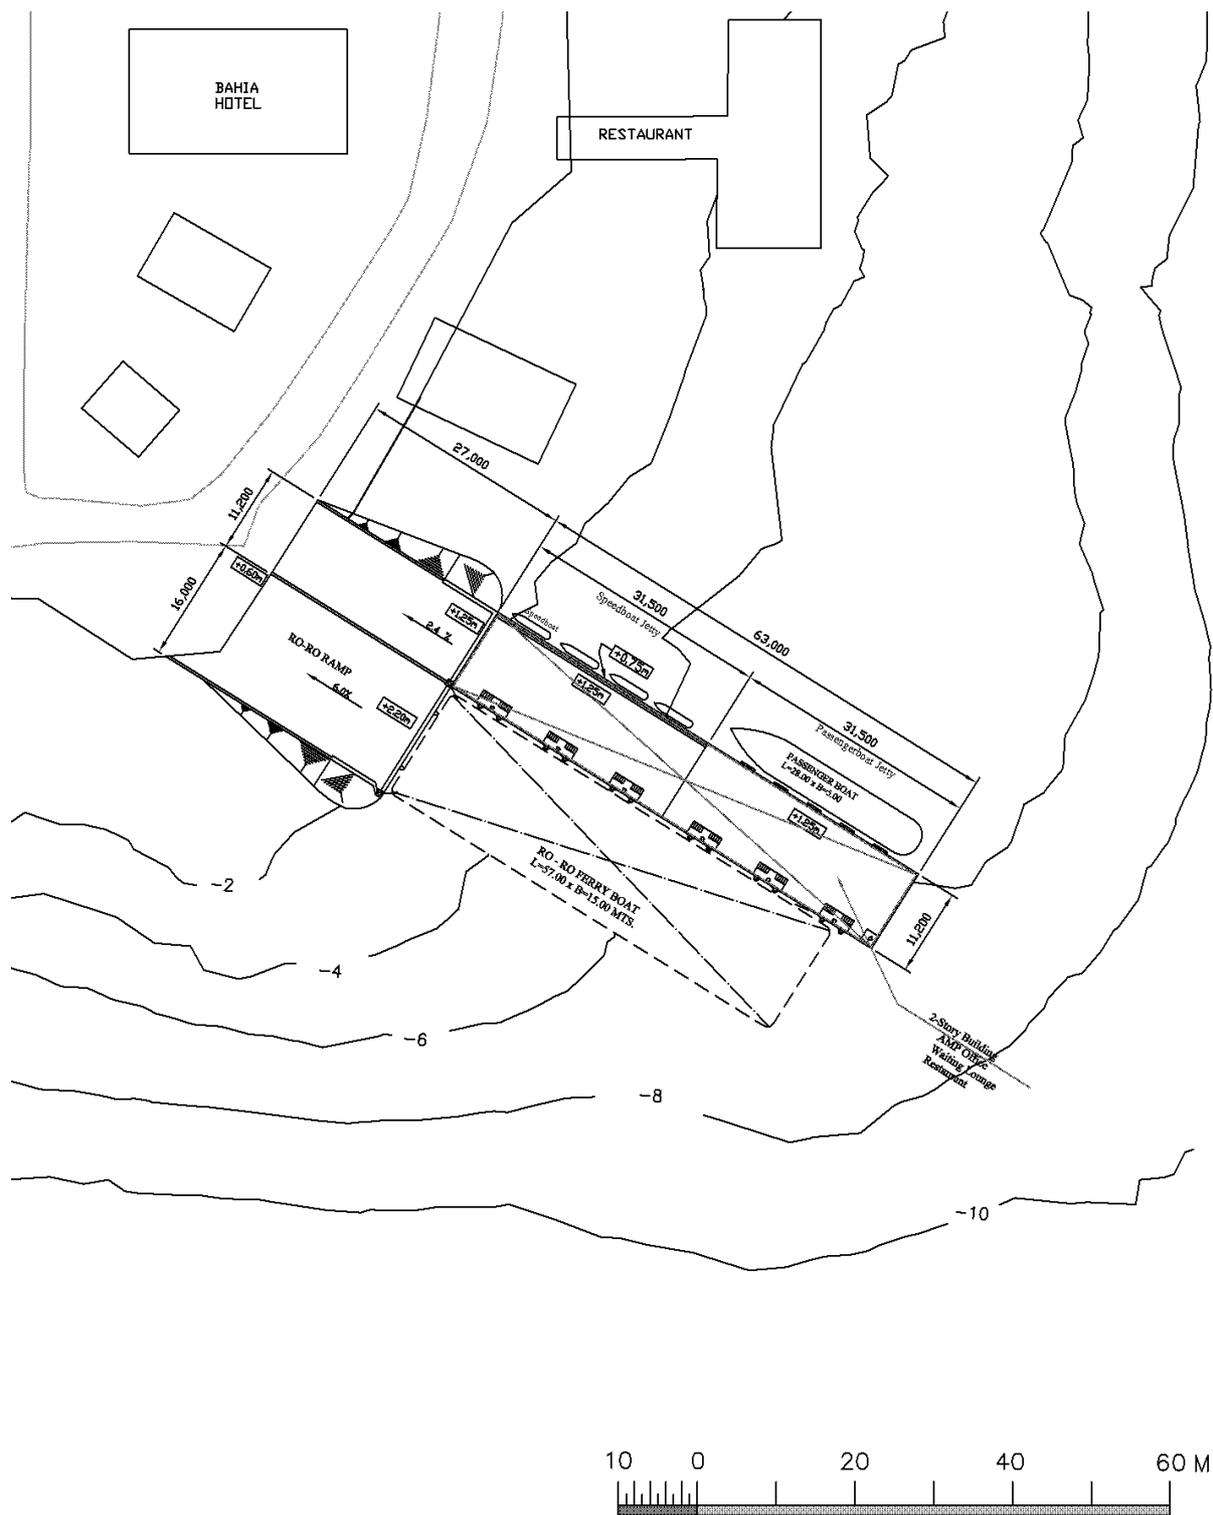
Plan General del Puerto de Bocas del Toro
